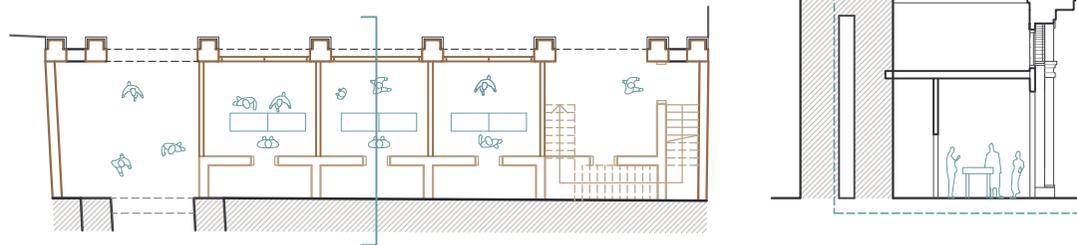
Planta baja y sección de la Casa de los Miradores, hacia 1583.
